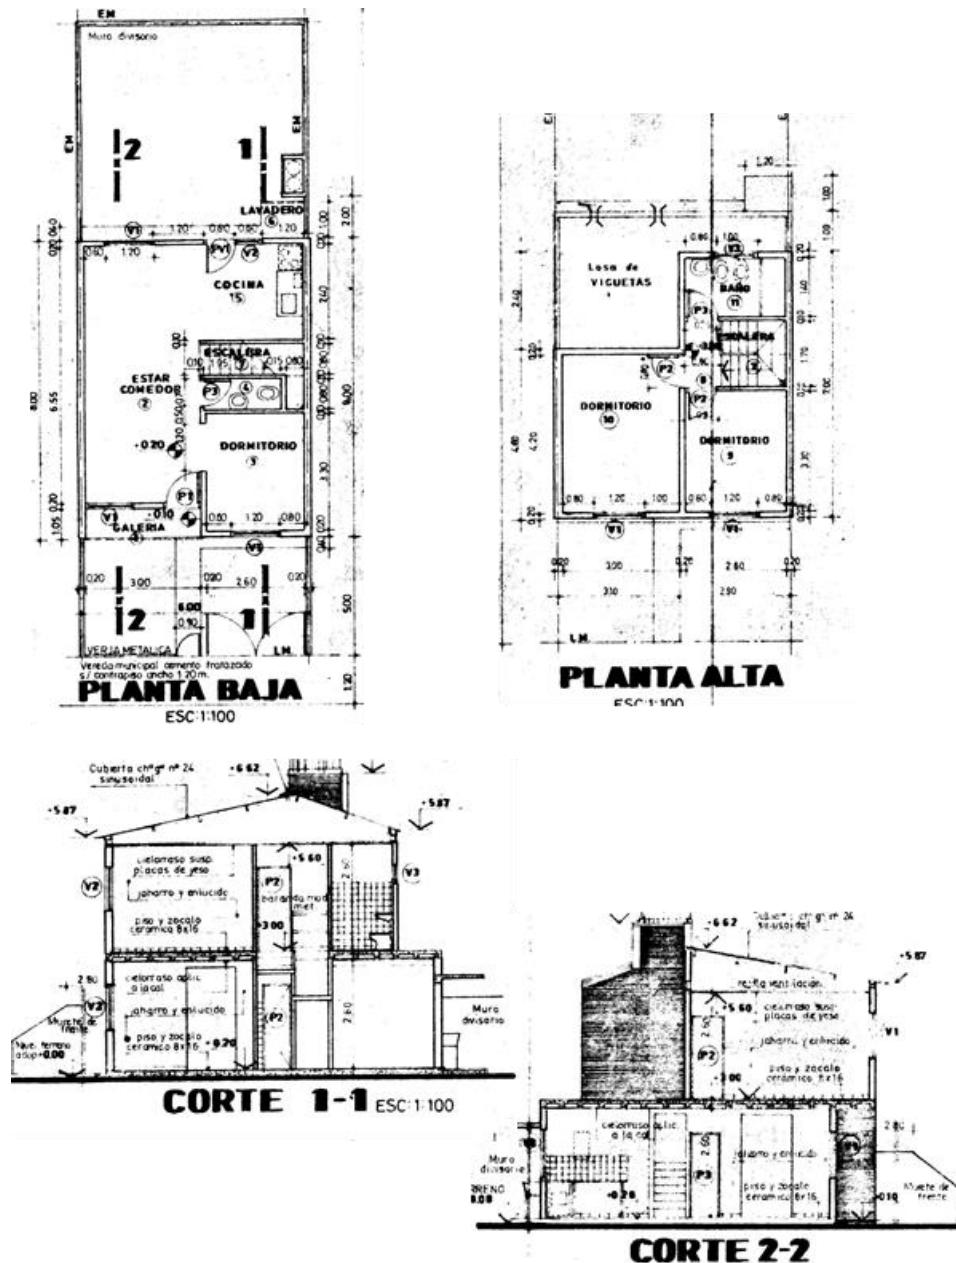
Plantas y Cortes de la vivienda del barrio MUPUNNE.
